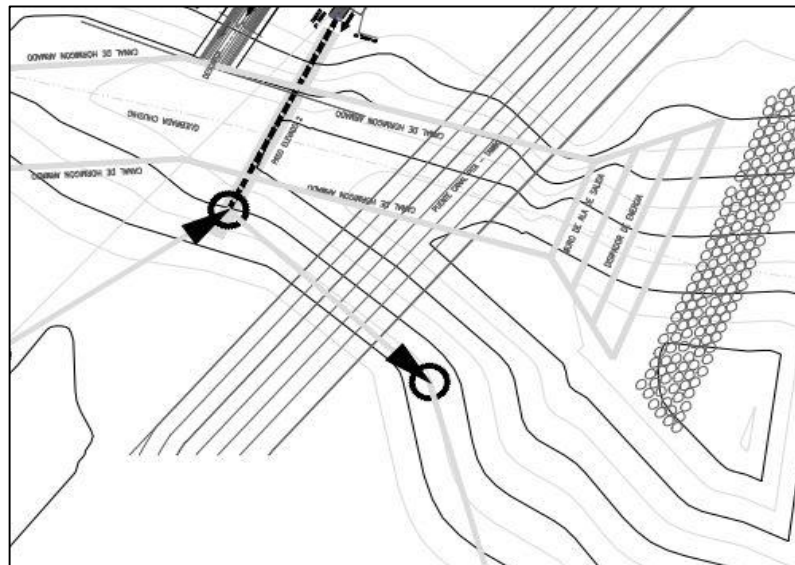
Vista en planta y perfil de la descarga del pozo 312
